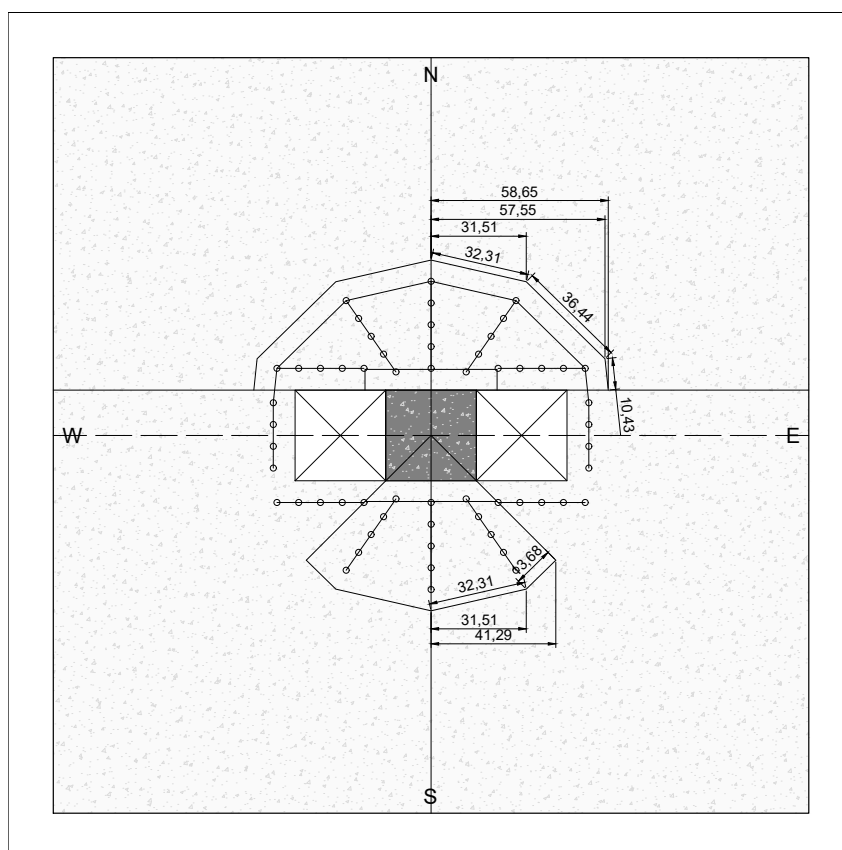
Perímetros externos segundo ACI 318-19 da laje LFS1
